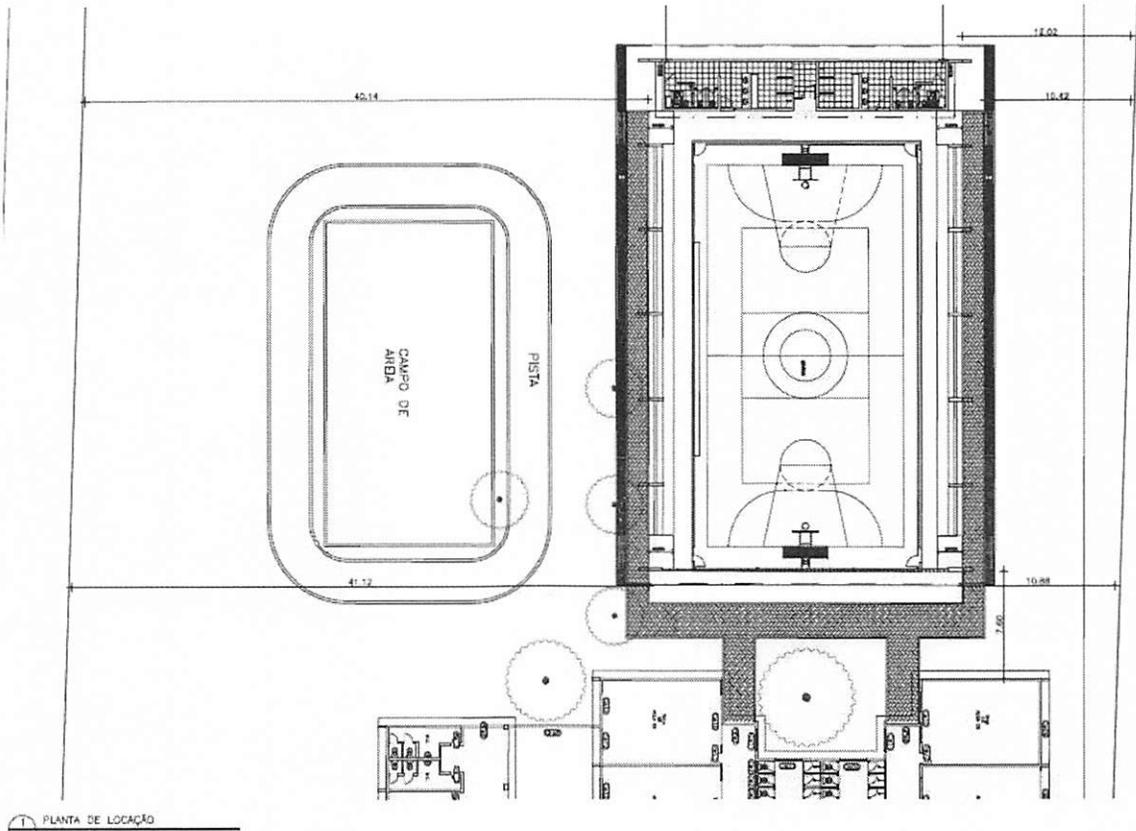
Planta de locação da obra no terreno. Exemplo Creche Pré-Escola
